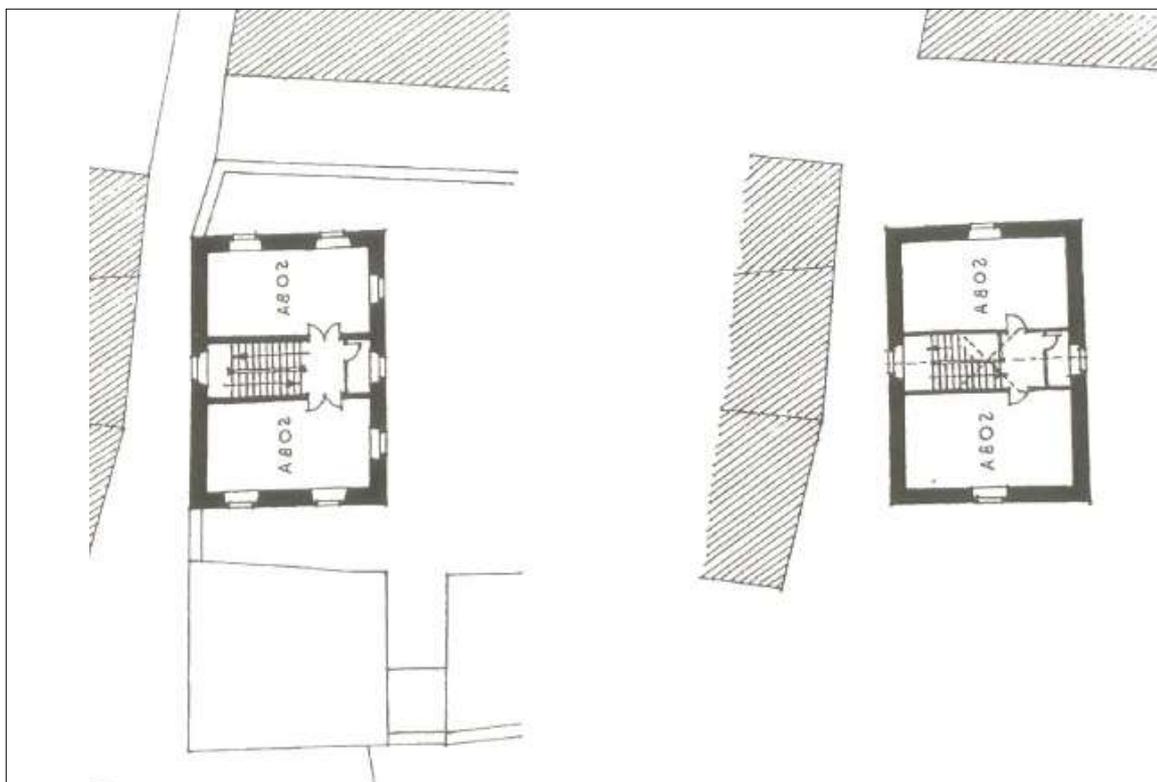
1. und 2. Stock mit zentralem Treppenhaus und zwei Zimmern. Der Grundriss zeigt ideal positionierte Fenster für Innen- und Außenraum, M 1:200
